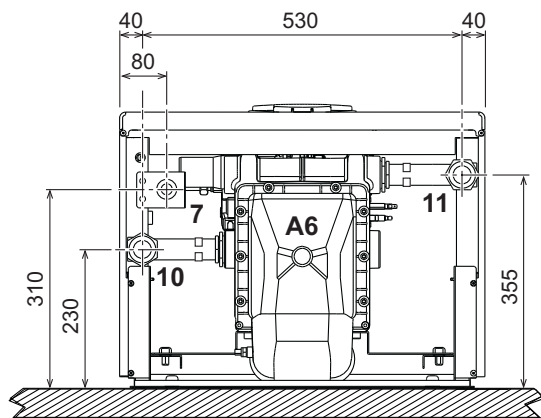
Vue de dessous mod. TORO W 60 et TORO W 80
